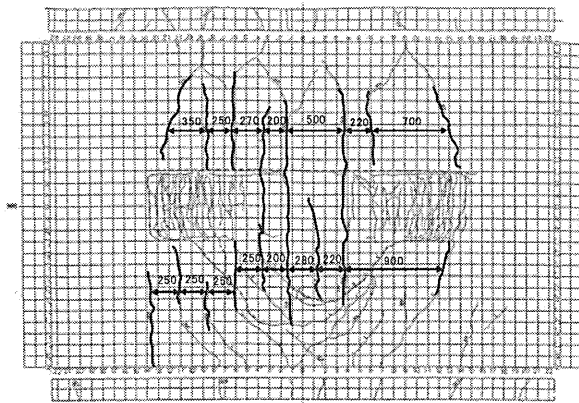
ショーボンド試験体の上面貫通ひび割れ間隔
